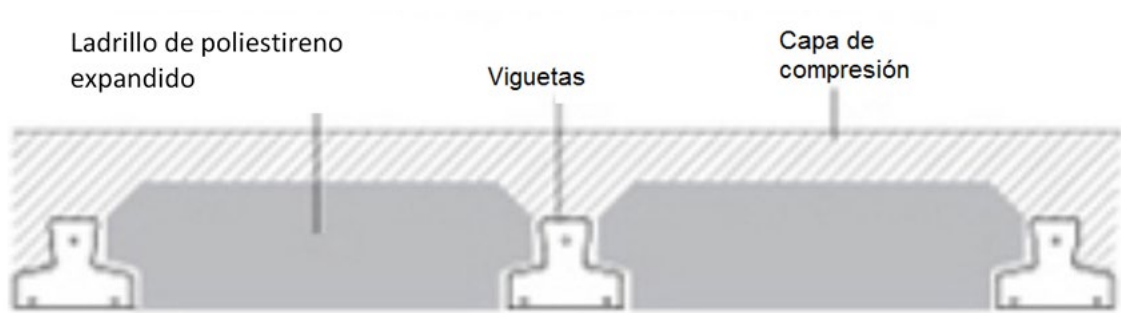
Esquema de losa con viguetas. Adaptado de [N-43]
